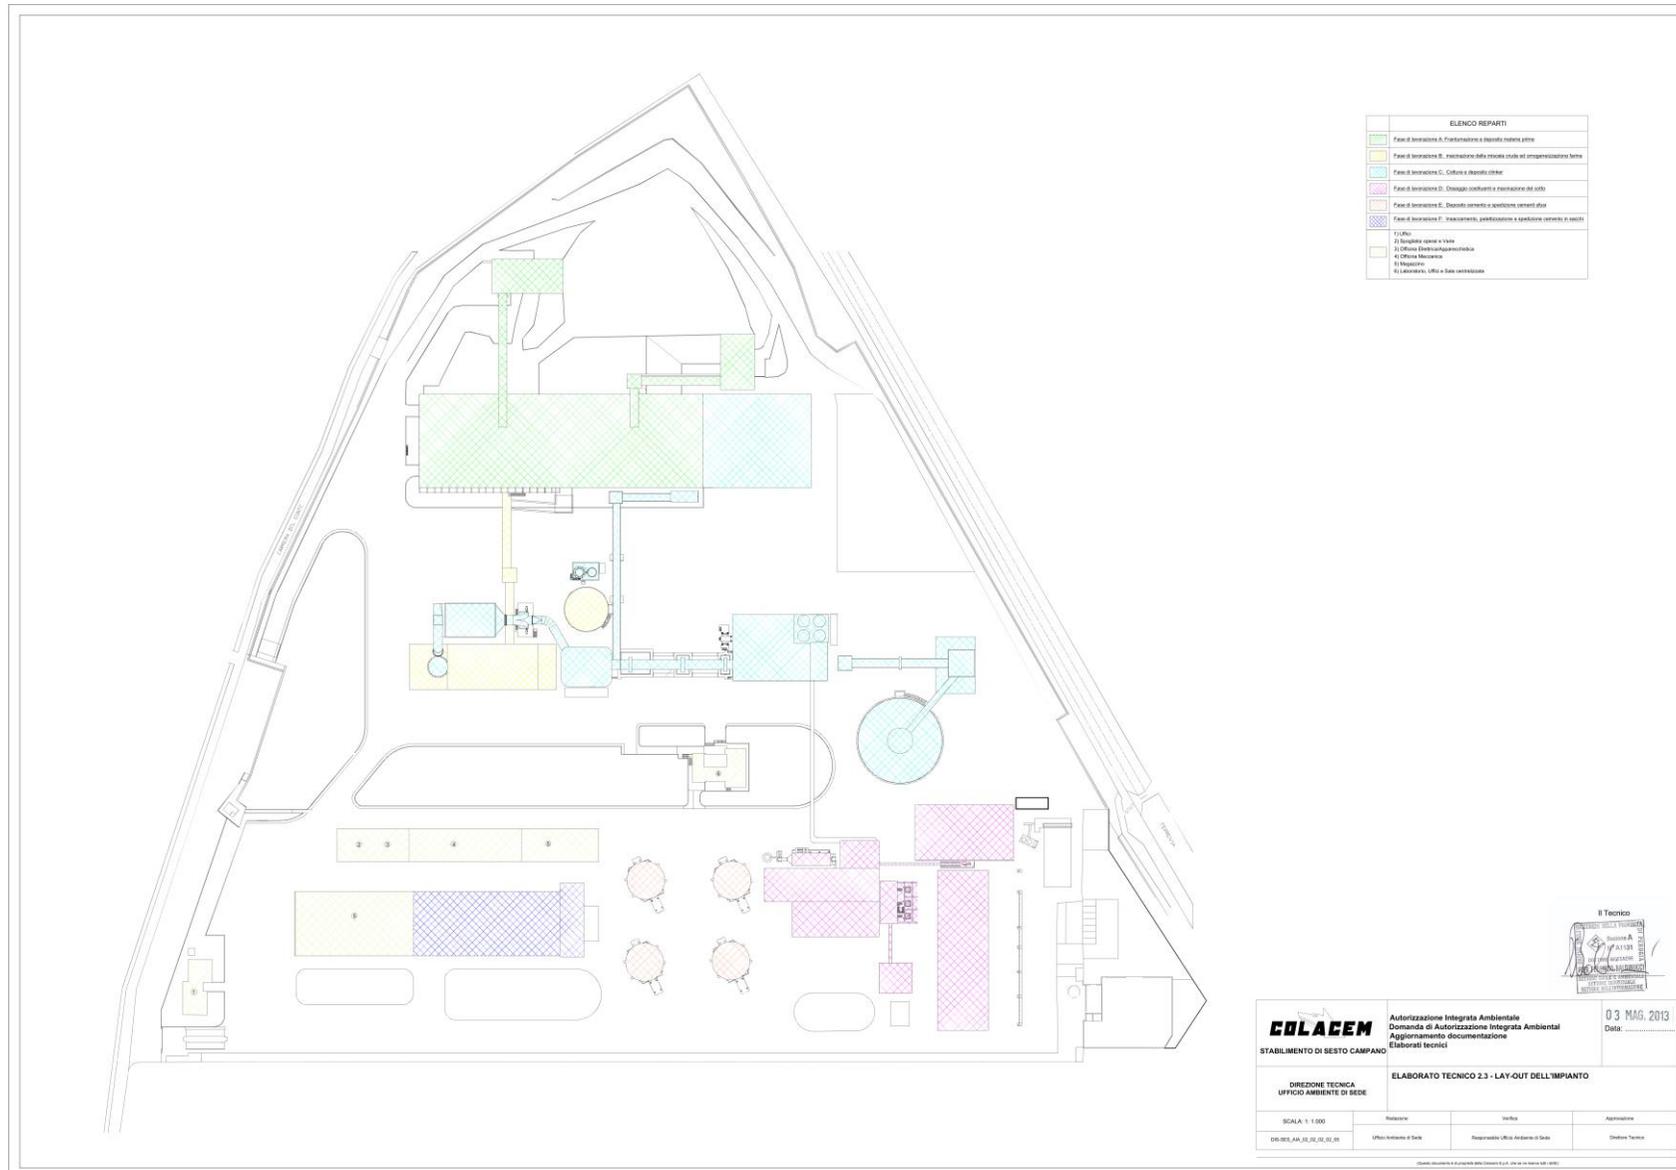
planimetria generale dell'installazione con indicazione delle fasi lavorative: assetto "ante operam"
